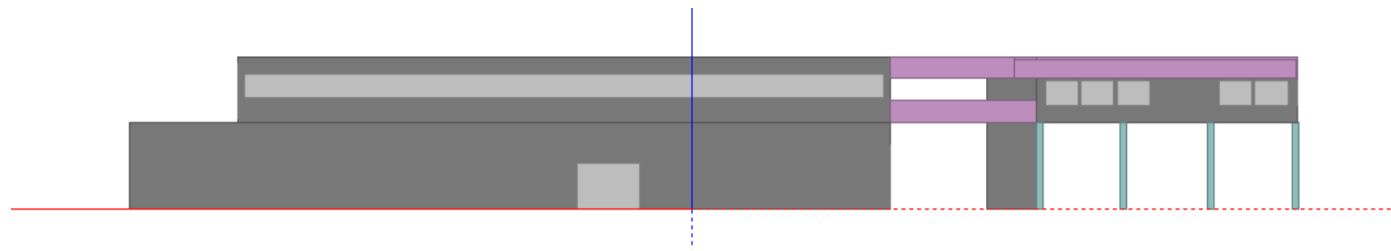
Alzado Oeste. Elaboración propia en Design Builder.
